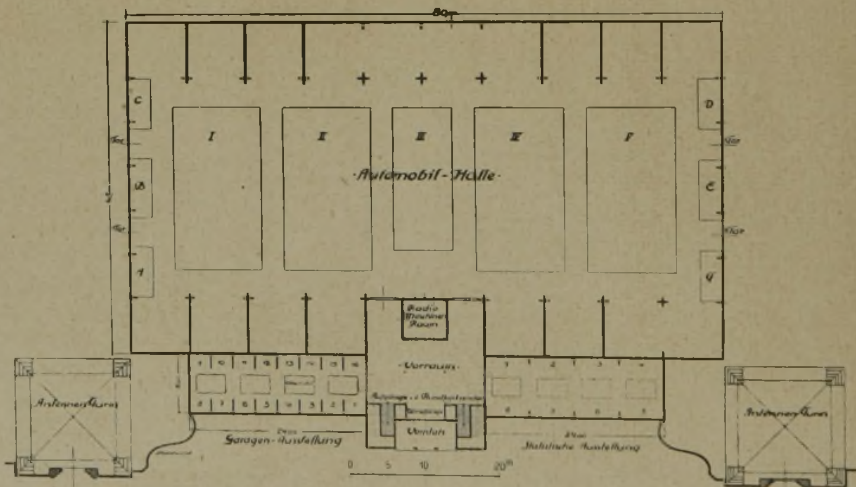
Grundriß des Erdgeschosses. (1 : 1000.)
